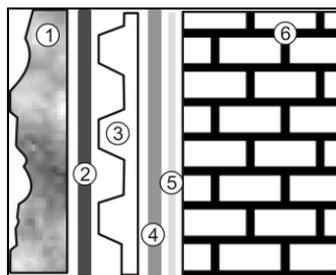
Пример вертикальной установки защитной системы для гидроизоляции, защиты и дренажа строительных конструкций в местах высокой гидростатической нагрузки: 1 — грунт; 2 — геотекстильный материал; 3 — профилированная мембрана с выступами; 4 — теплоизоляция; 5 — гидроизоляция; 6 — кирпичная кладка
